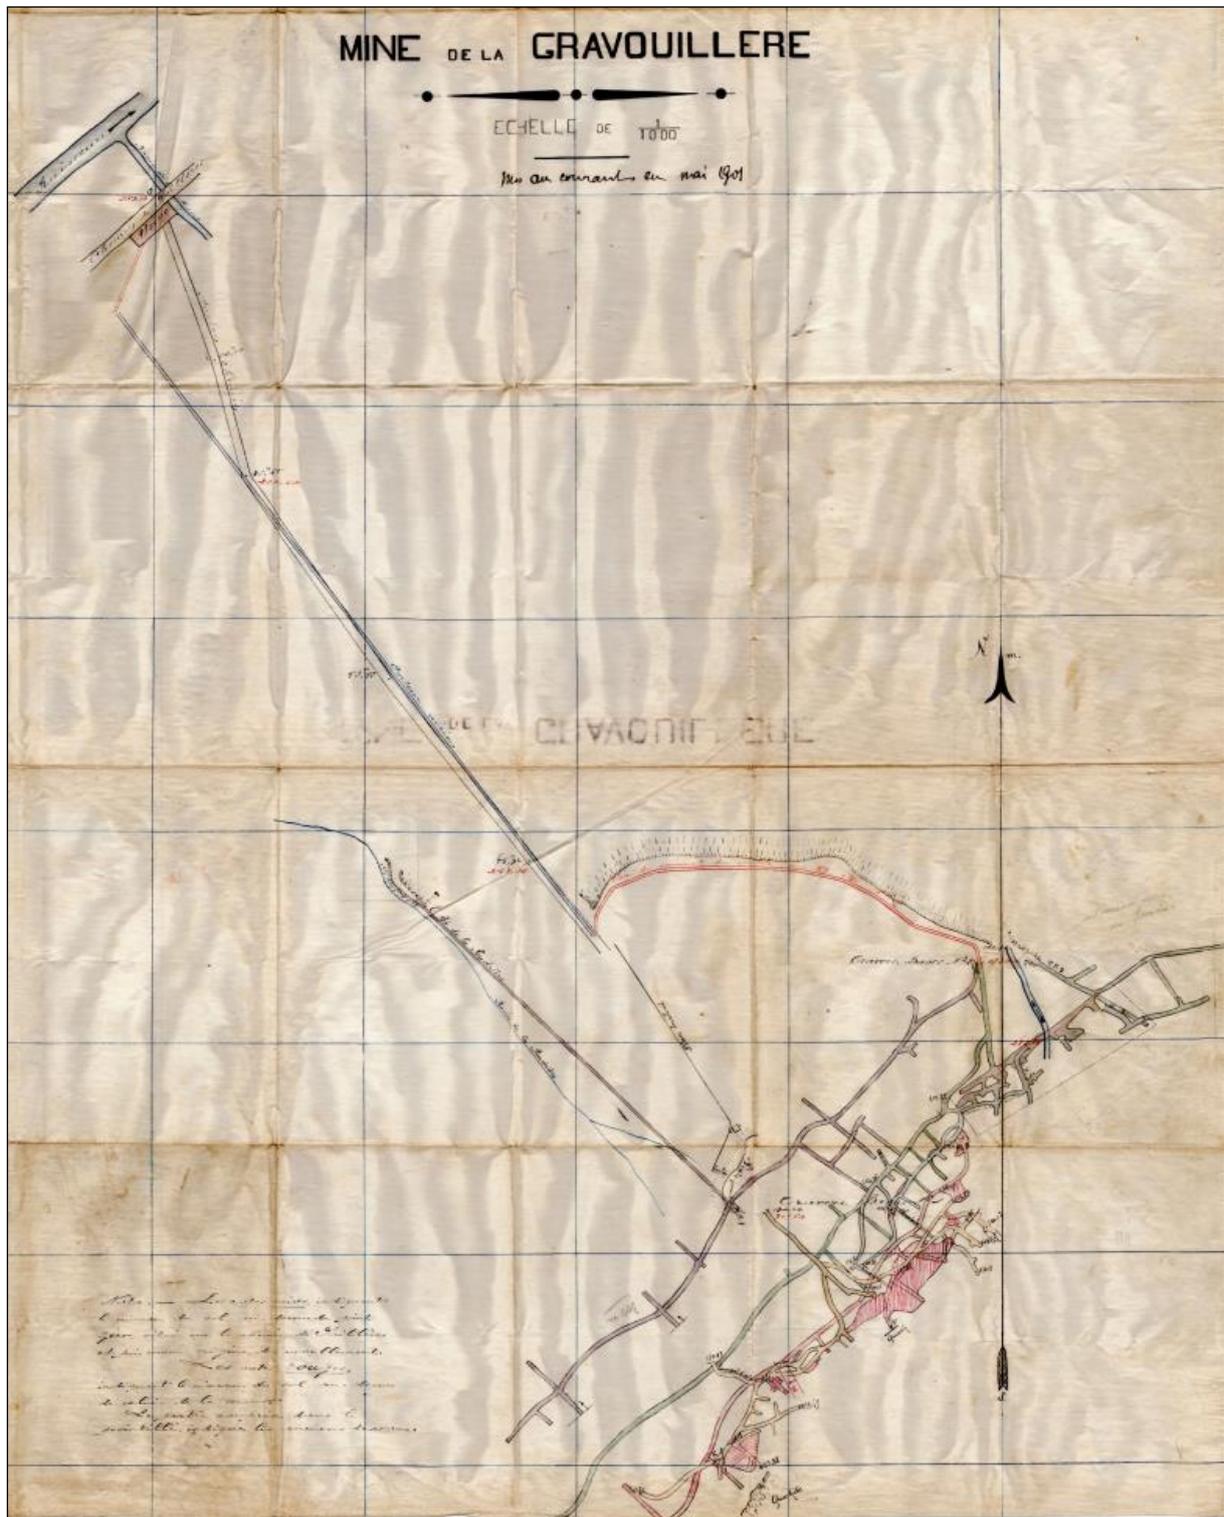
Mine de la Gravouillère, plan des travaux de 1901
